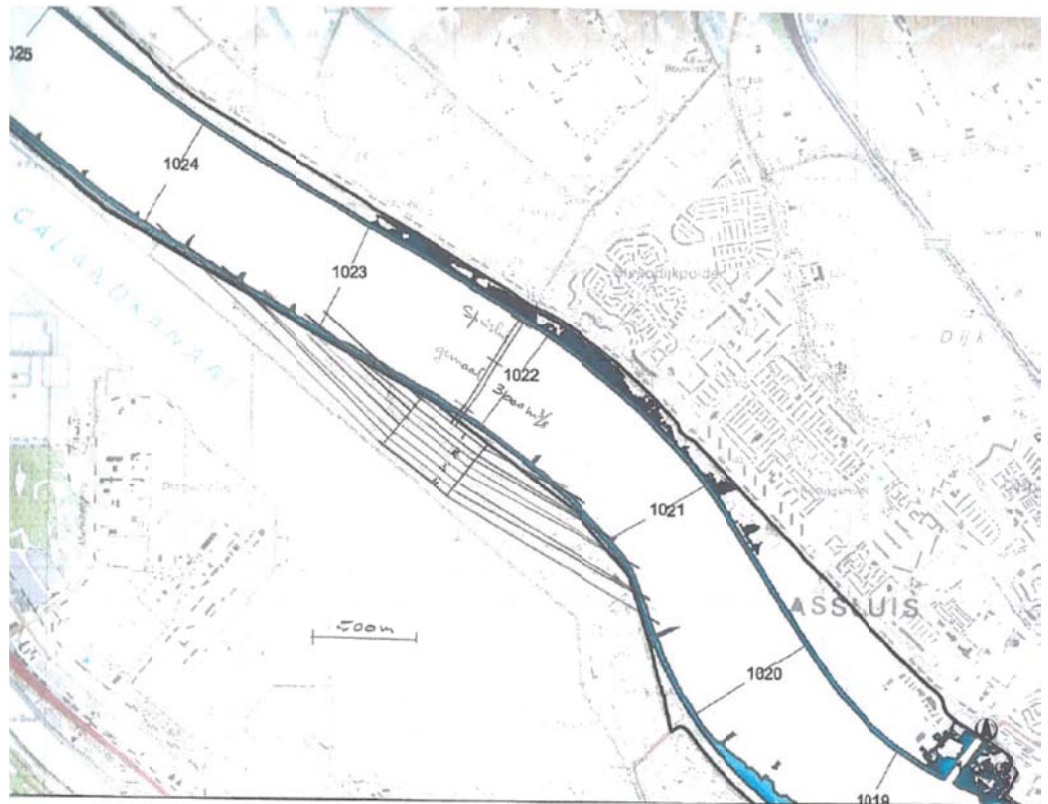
Alternatief voor Plan Sluizen bij Maassluis.
